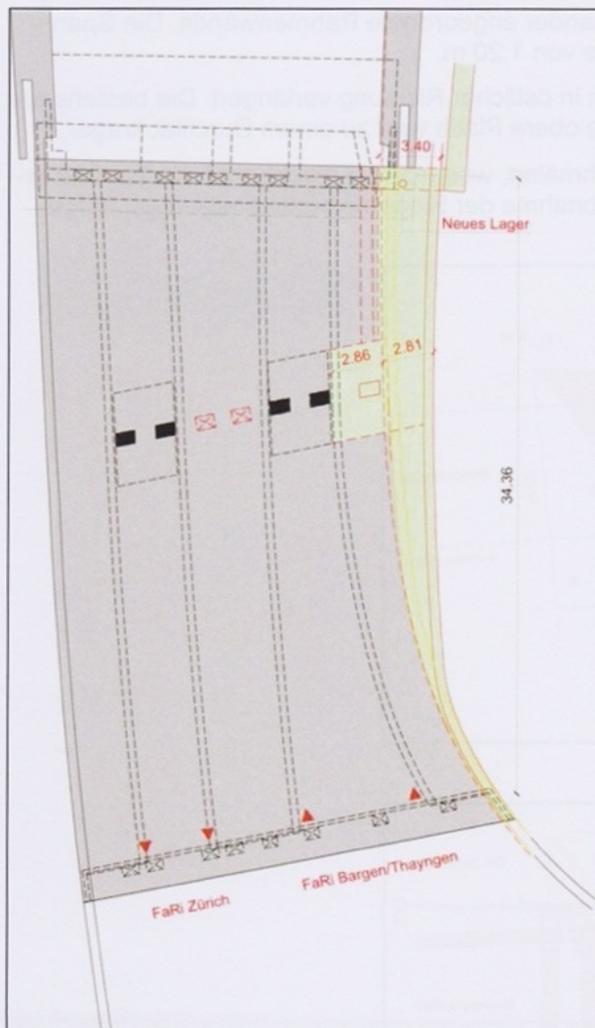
Verbreiterung der Brücke über Mühlenstrasse, Grundriss
